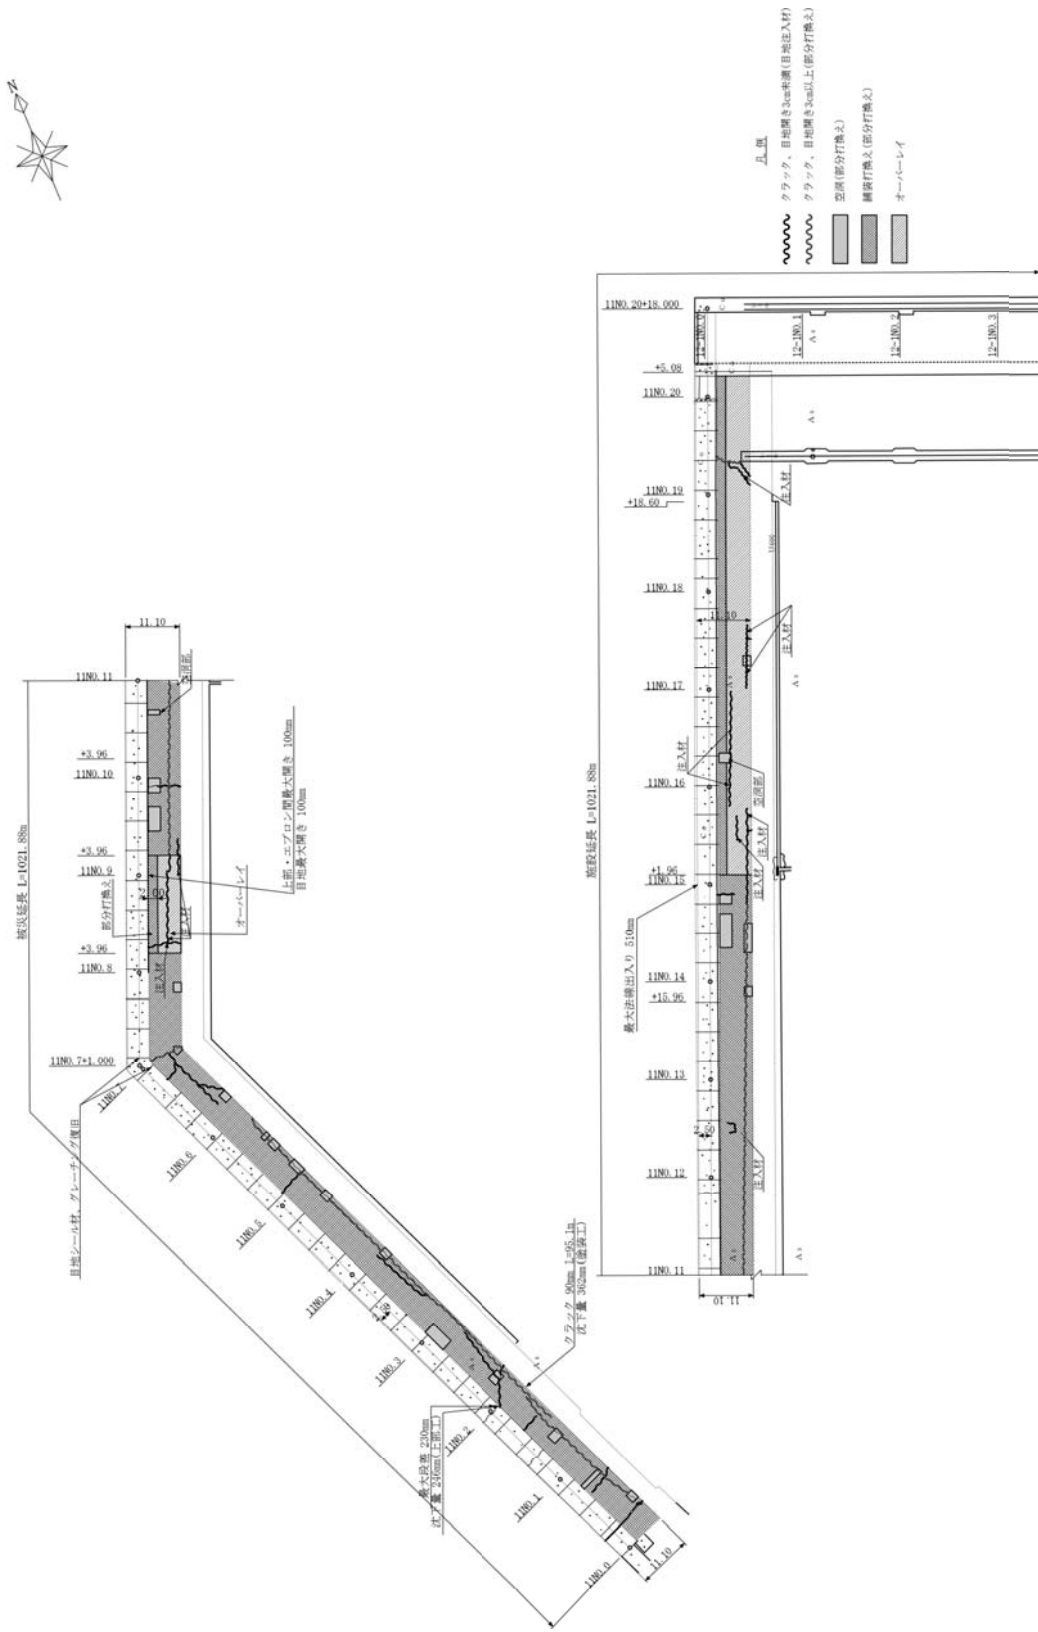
(a) 香椎パークポート地区-13m 栈橋護岸部の被災・復旧平面図
